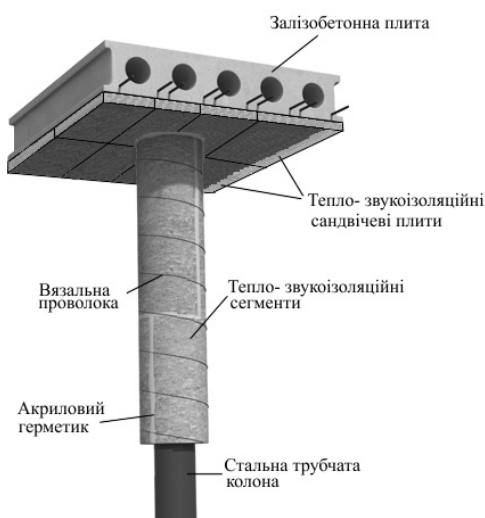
Облаштування звукоізоляції стелі з багатопустотної залізобетонної плити, яка опирається на стальну колону кільцевого перерізу
